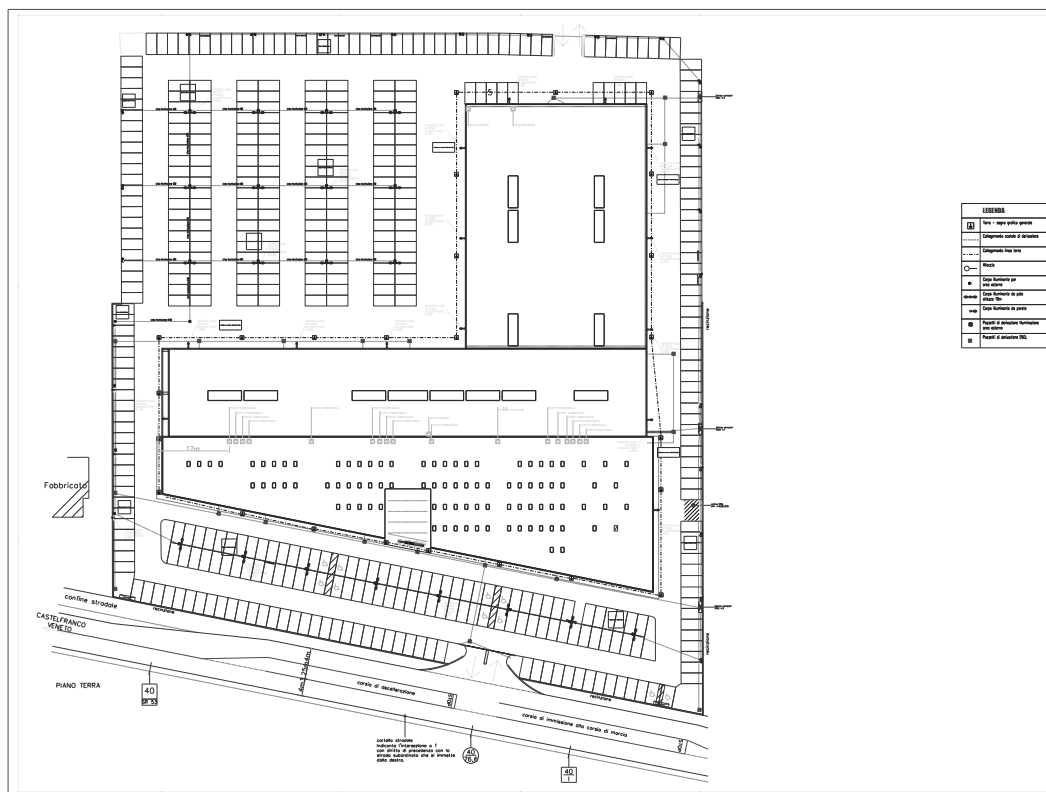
Pianta dell'edificio, con indicate le aree destinate ai parcheggi e le macchine in copertura
